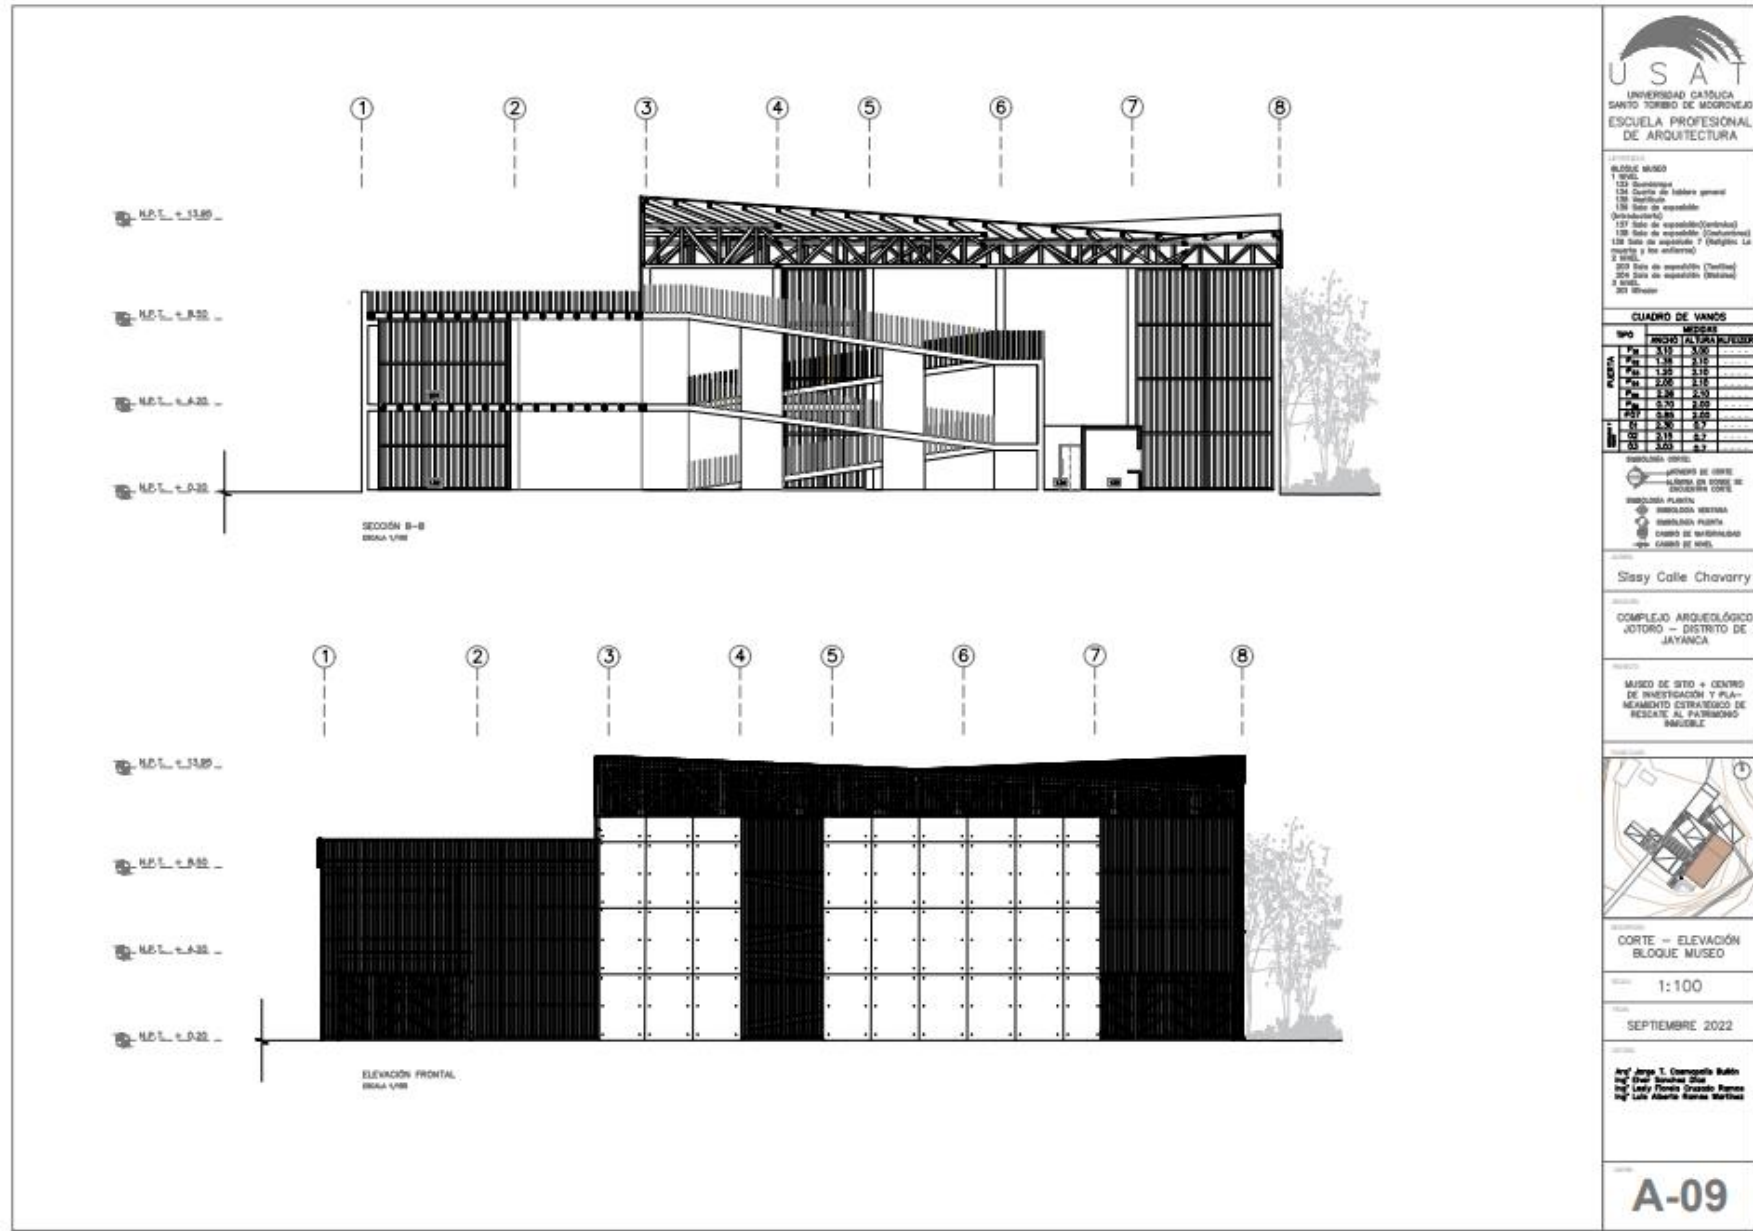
Planos de detalle bloque museo. Fuente: Propia
